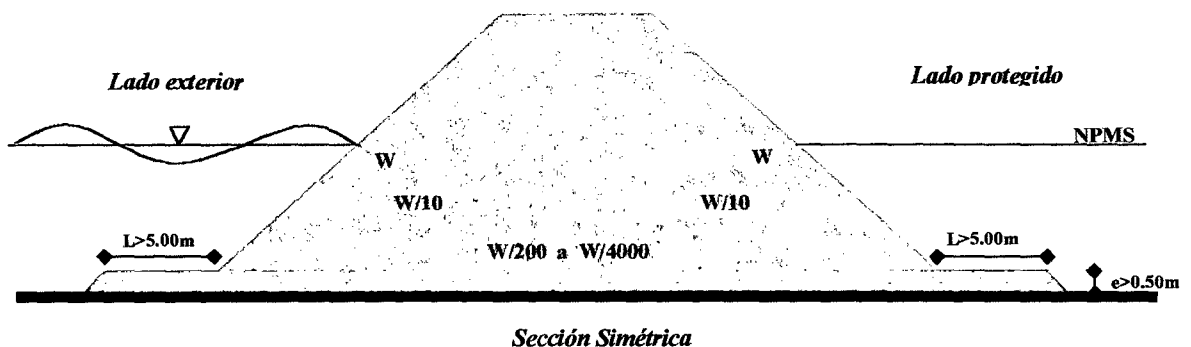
SECCIÓN TRANSVERSAL PARA EL MORRO DE UNA ESCOLLERA FORMADA CON ENROCAMIENTO O ELEMENTOS PREFABRICADOS
